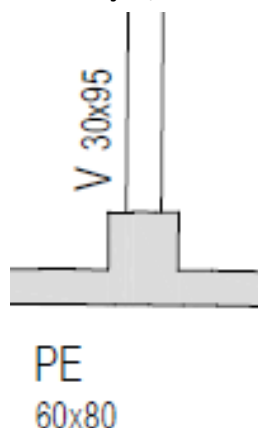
DETALHE TÍPICO DOS PILARES (DEMAIS EIXOS)
